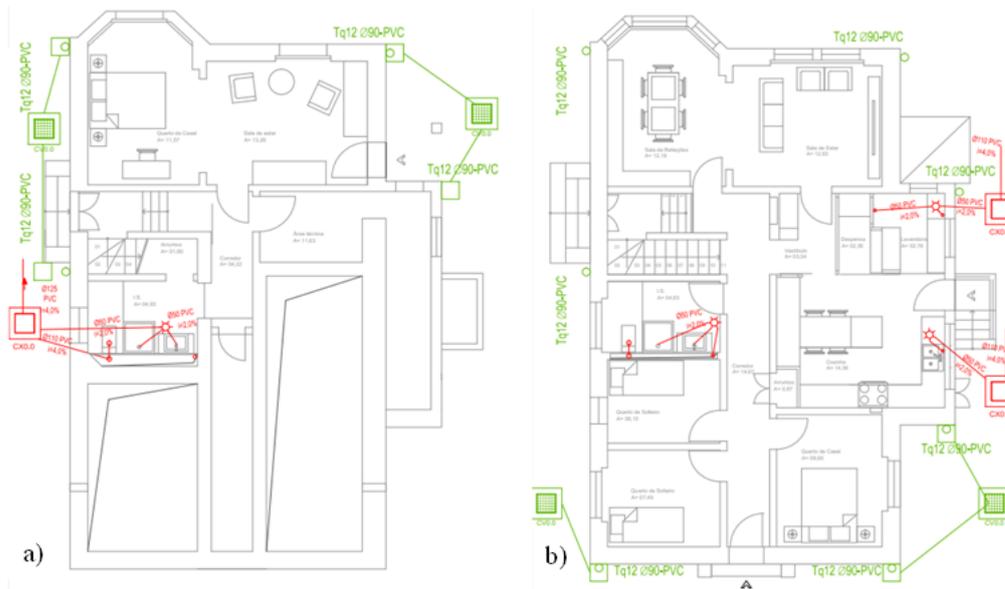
15 - Rede de águas pluviais e esgotos, a) planta do piso 0; b) planta do piso 1, (Fonte: de autor).
